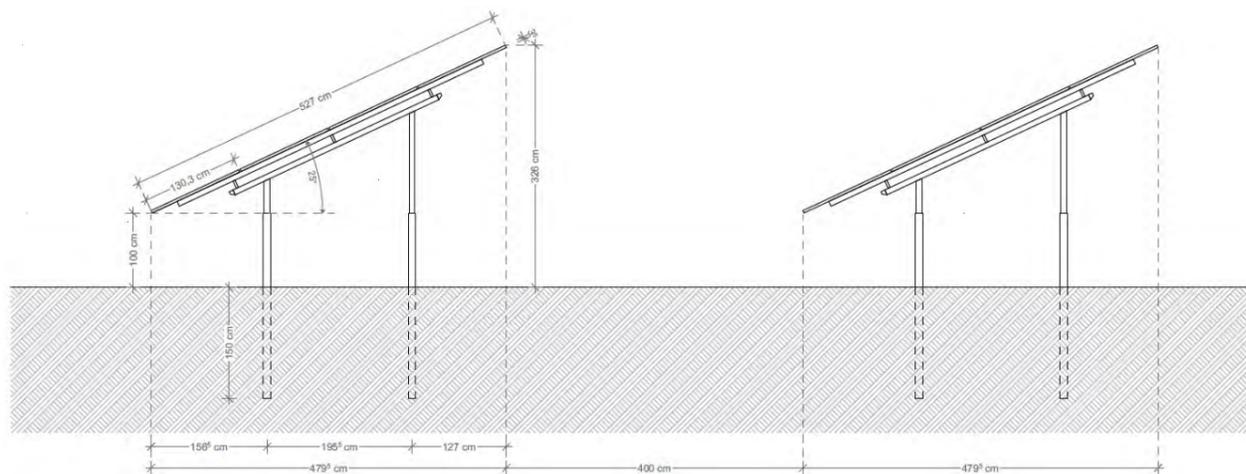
Plan de coupe et de façade des tables photovoltaïques
